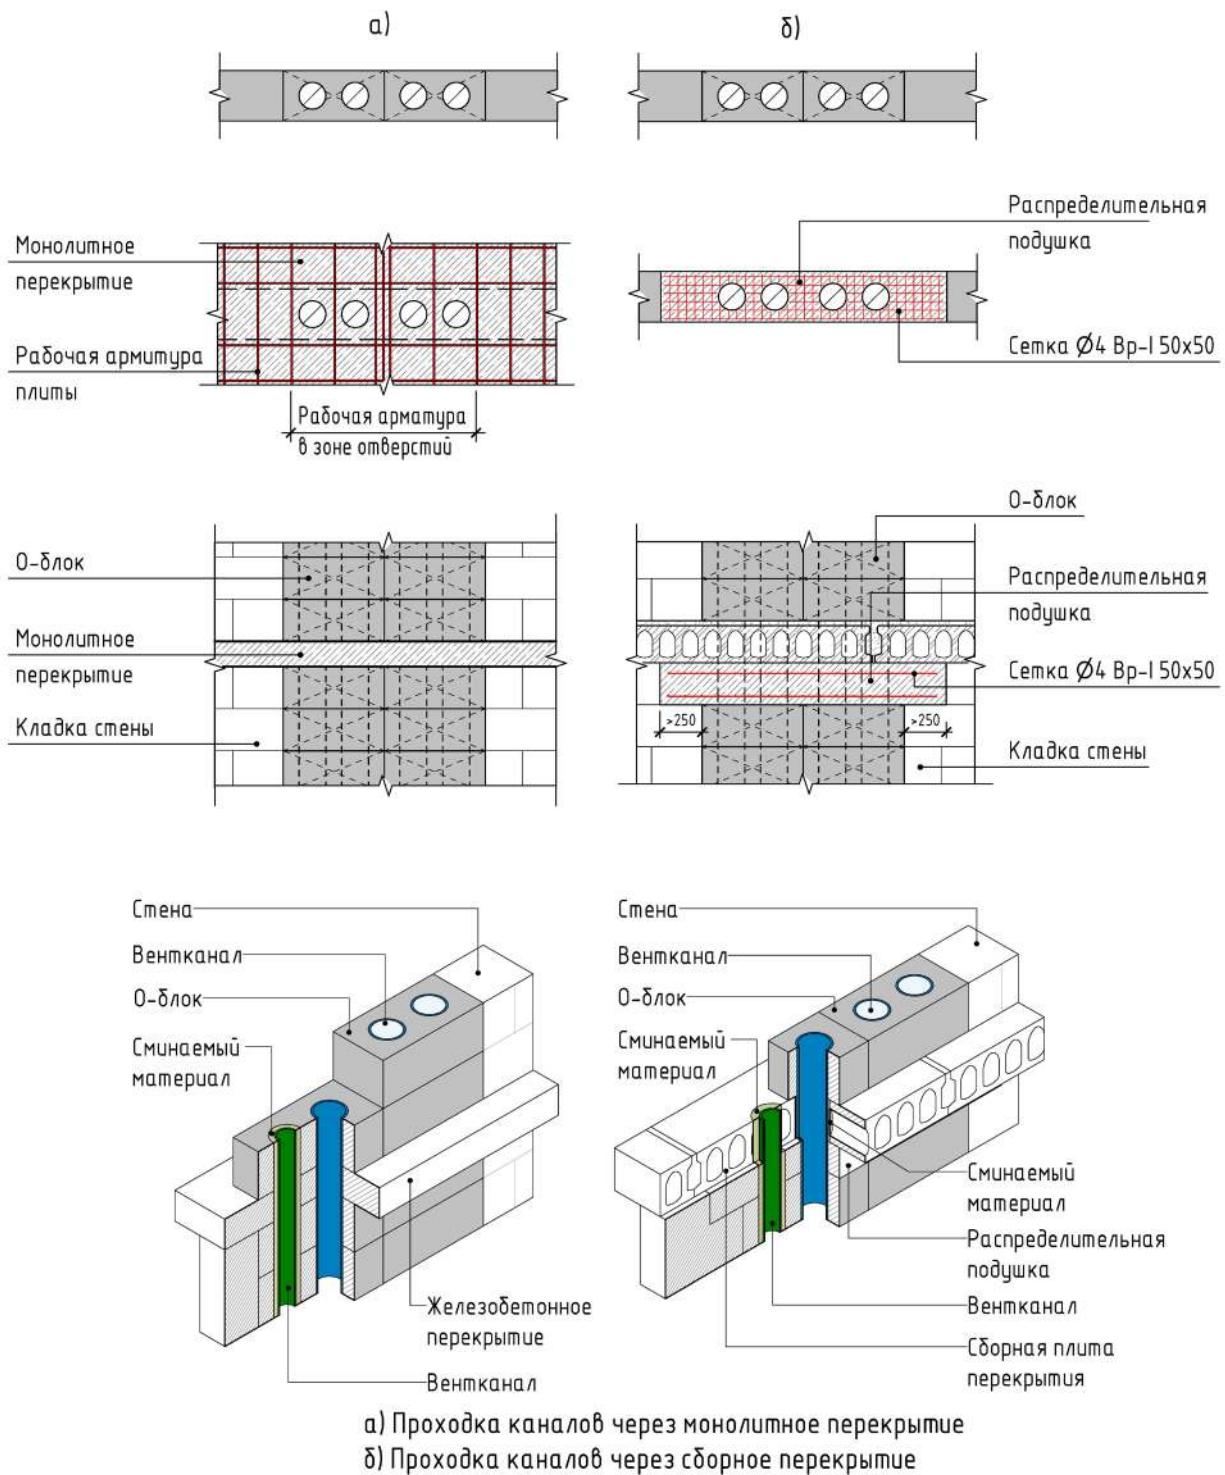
Варианты проходки каналов в составе несущих стен через перекрытия
